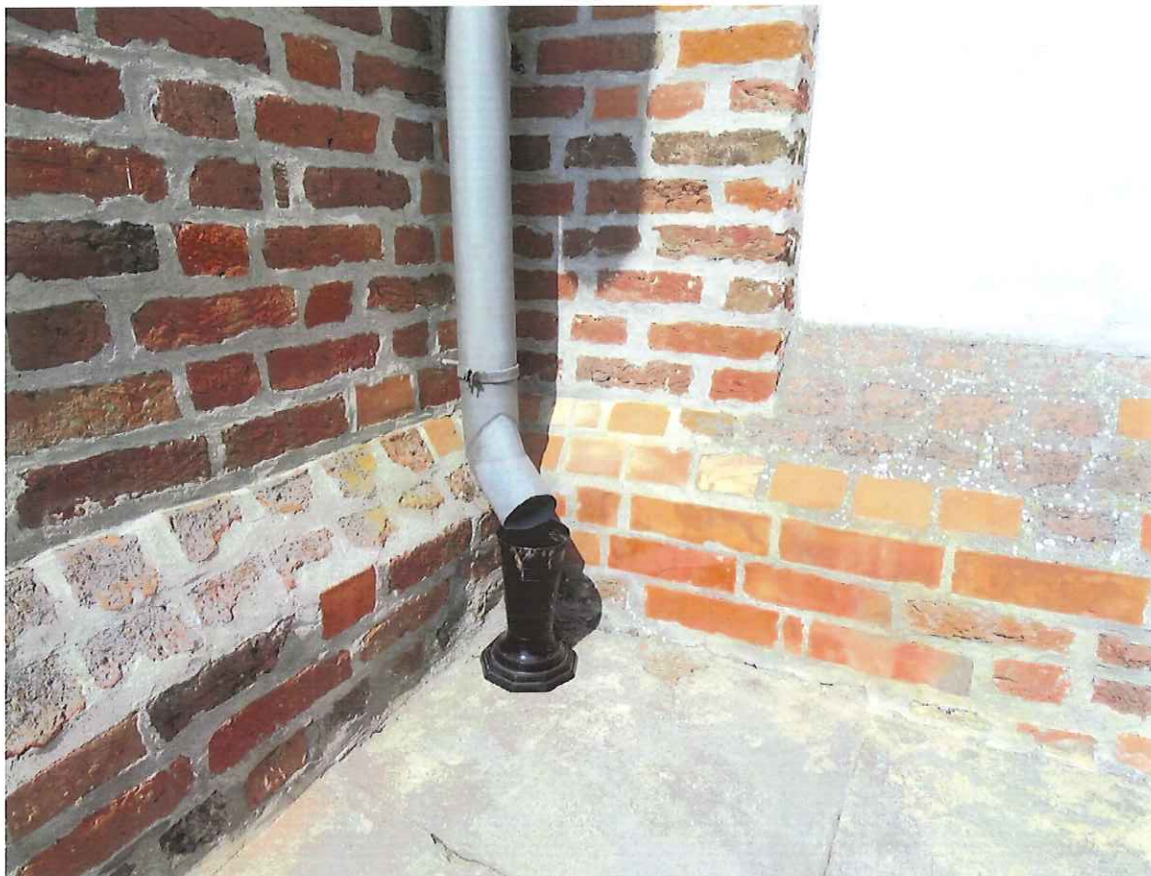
Fragment wschodniej elewacji kościoła, korozja mikrobiologiczna, sierpień 2023 r.
